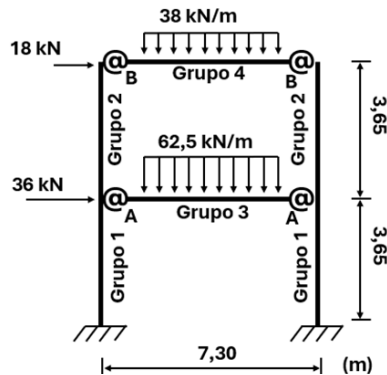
Pórtico plano: 2 pavimentos e 1 vão, adaptado de Simões (1996)
